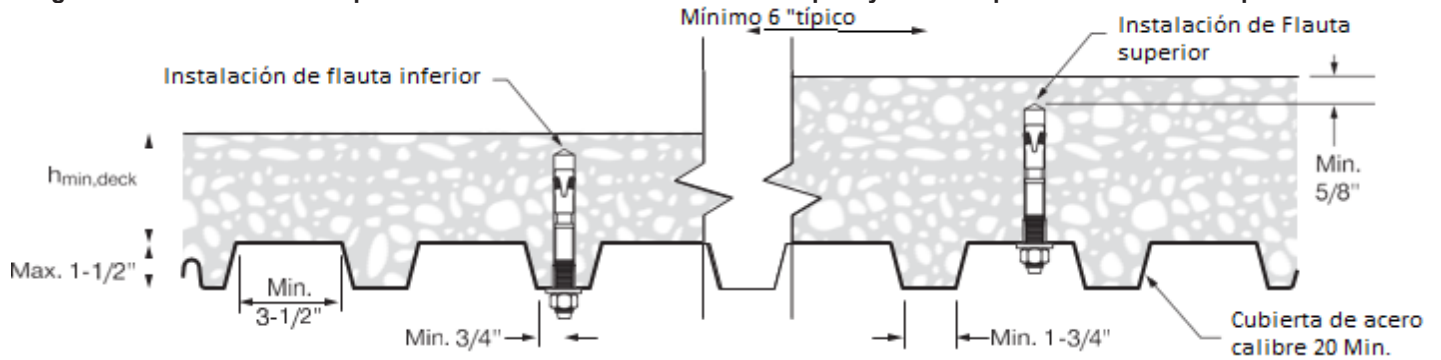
Instalación en el plafón de concreto sobre ensambles de piso y techo de plataforma metálica - plataforma B
